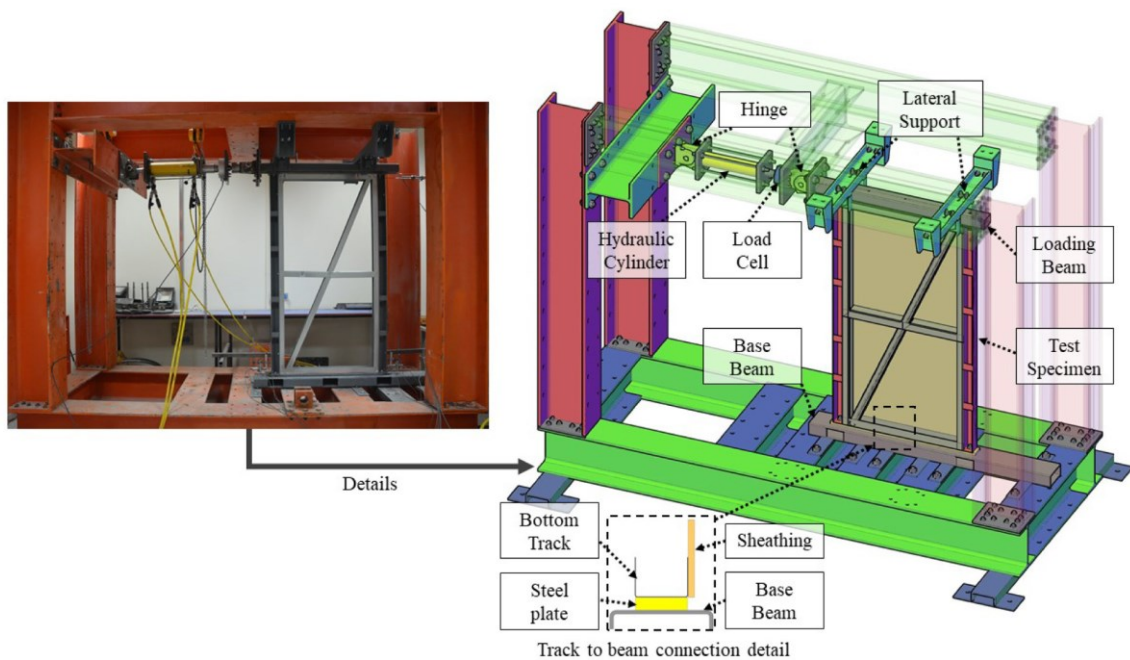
Vistas esquemáticas da configuração do teste. (AKTEPE et al., 2023)
